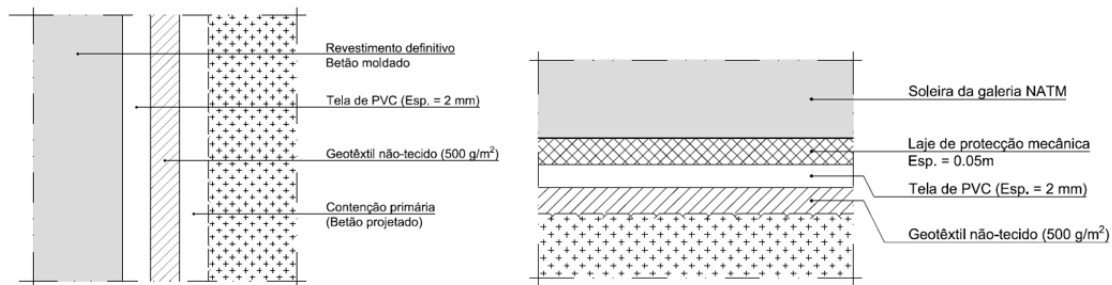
Sistema de impermeabilização do revestimento definitivo do túnel de ligação
